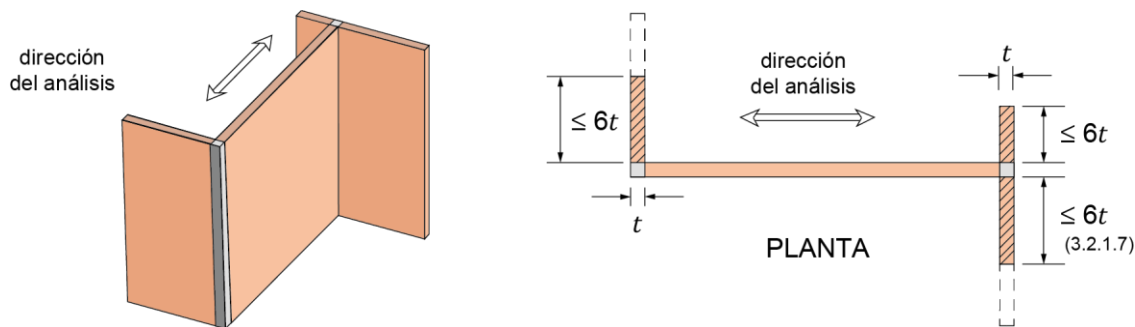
Ancho efectivo del patín a compresión en muros para análisis a base de marcos planos
